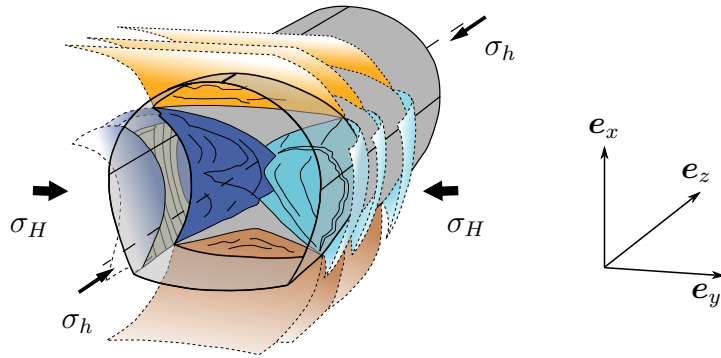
Faciès de fissuration observé par l'ANDRA lors de l'excavation d'un tunnel dans la direction de la contrainte principale horizontale mineure (figure ANDRA)
